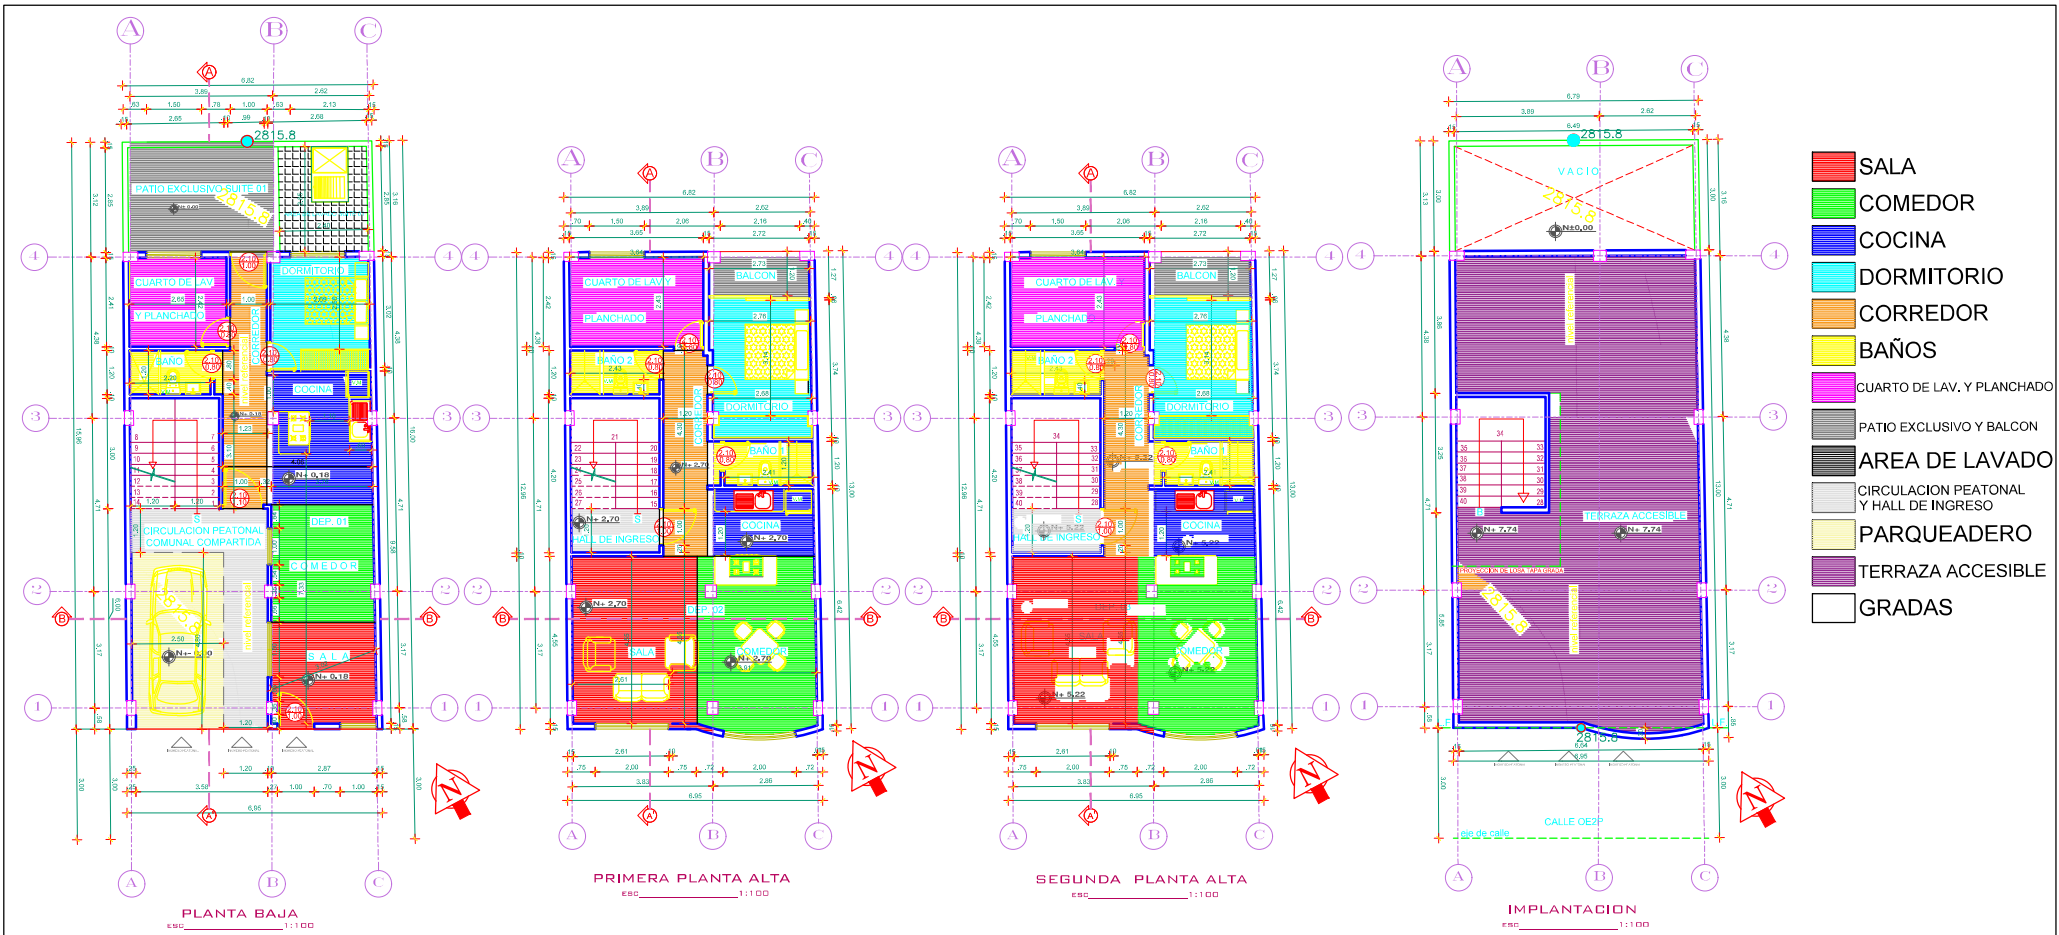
Plantas arquitectónicas de implementación del proyecto base.
